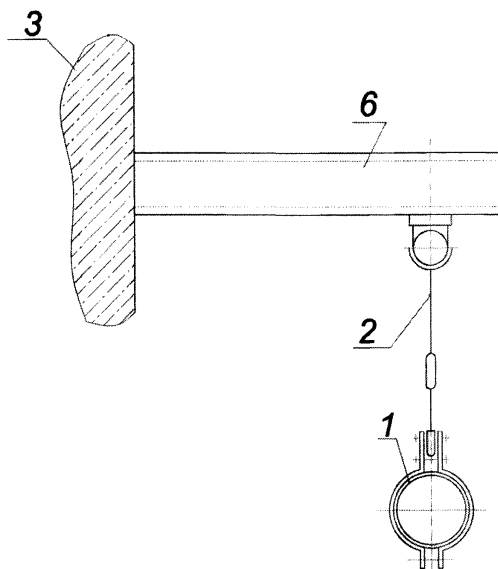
Пример назначения границ между опорными конструкциями и строительными конструкциями
